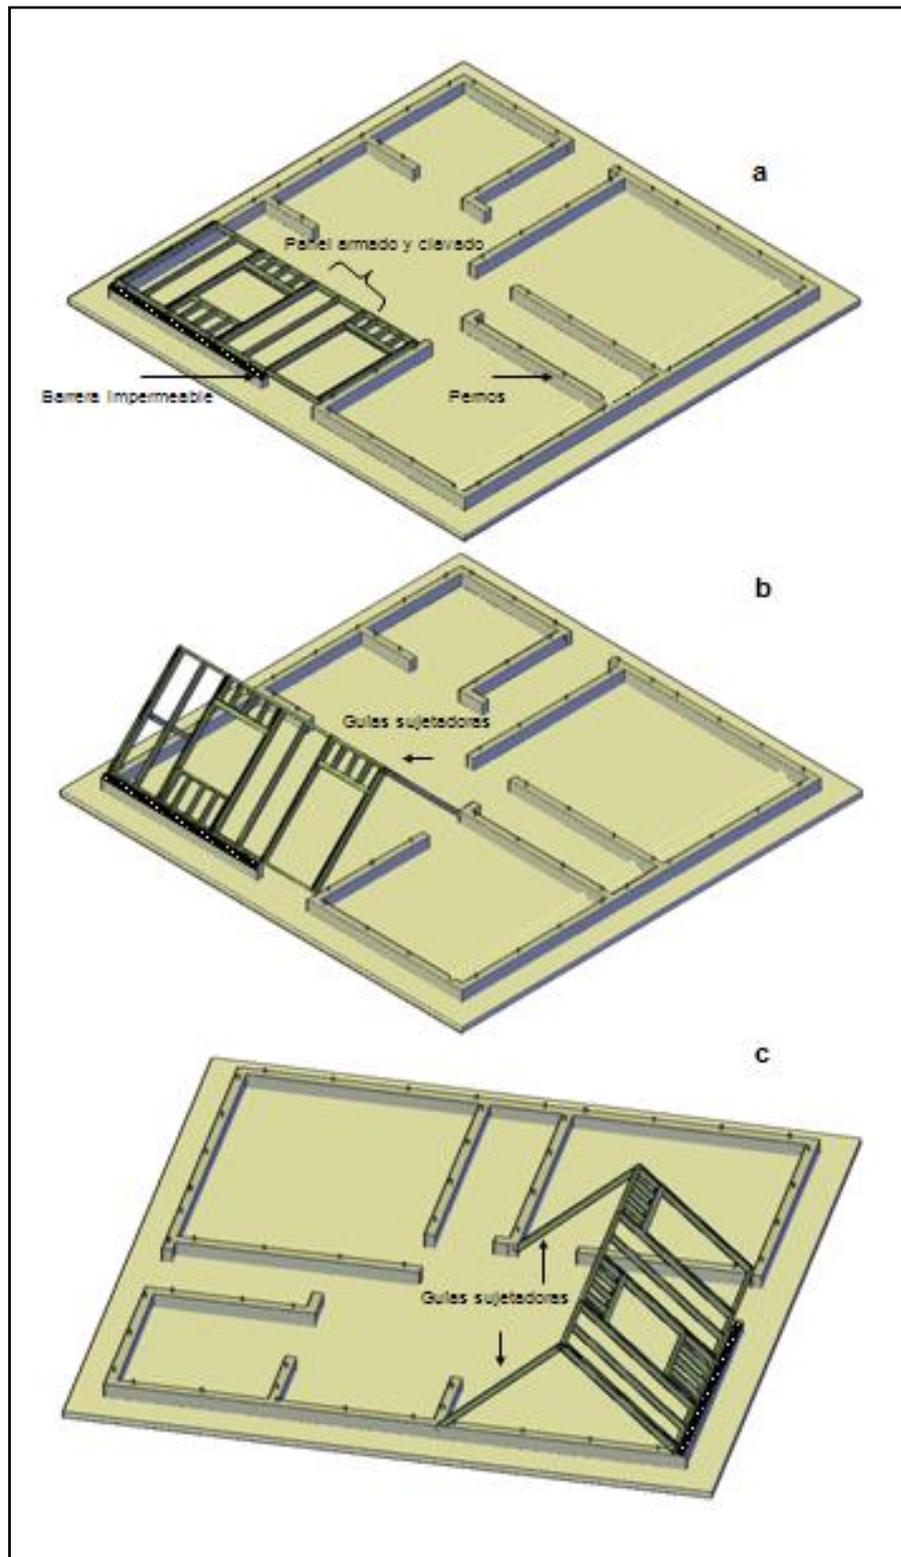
Levantado del panel: a) Colocación de la barrera impermeable en la cadena de sobrecimiento; b) y c) Colocación de guías sujetadoras del panel.
